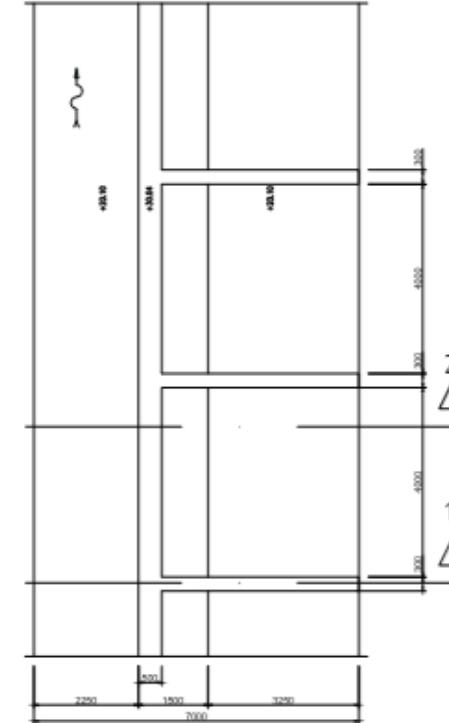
Detail Penulangan dan Denah Tampak Atas Dinding Penahan Tanah Tipe B
